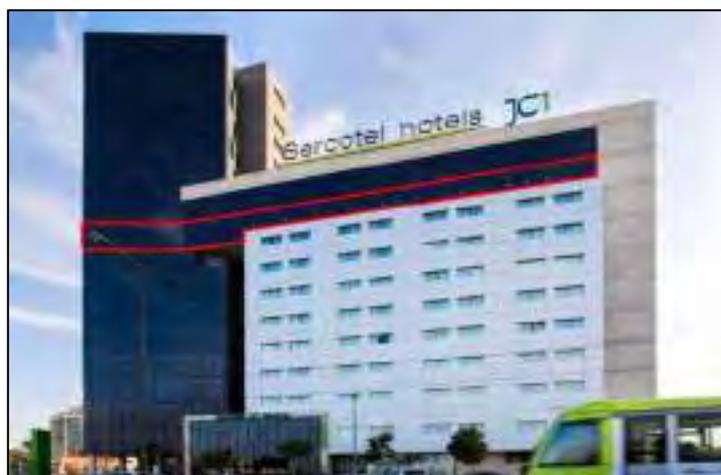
Detalle de fachada principal e indicación de planta.
